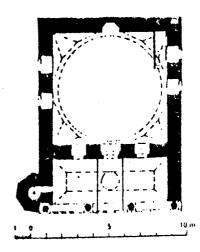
مسقط أفقي لمسجد الحيدرية بقزوين . (عن : بوب) .
